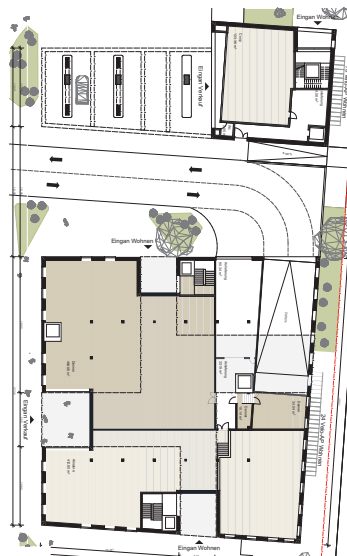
Erdgeschoss (Vorprojekt, 19.11.20)
